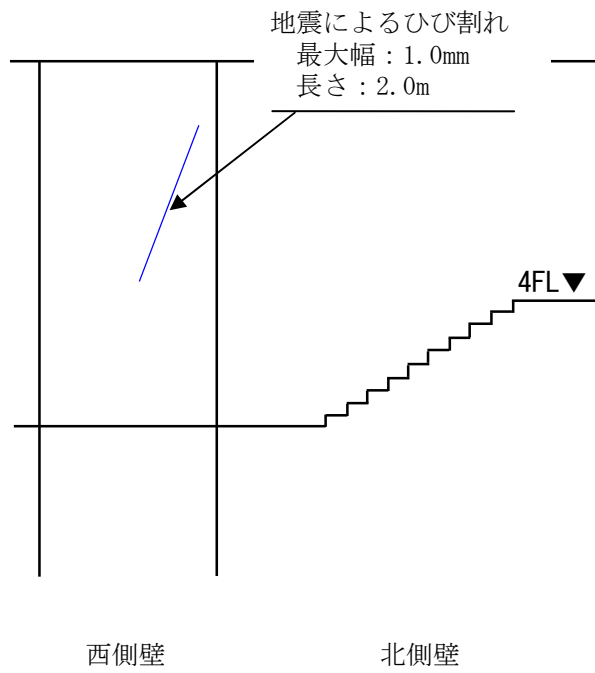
ひび割れの発生状況 分離精製工場 (4F A043 室)
